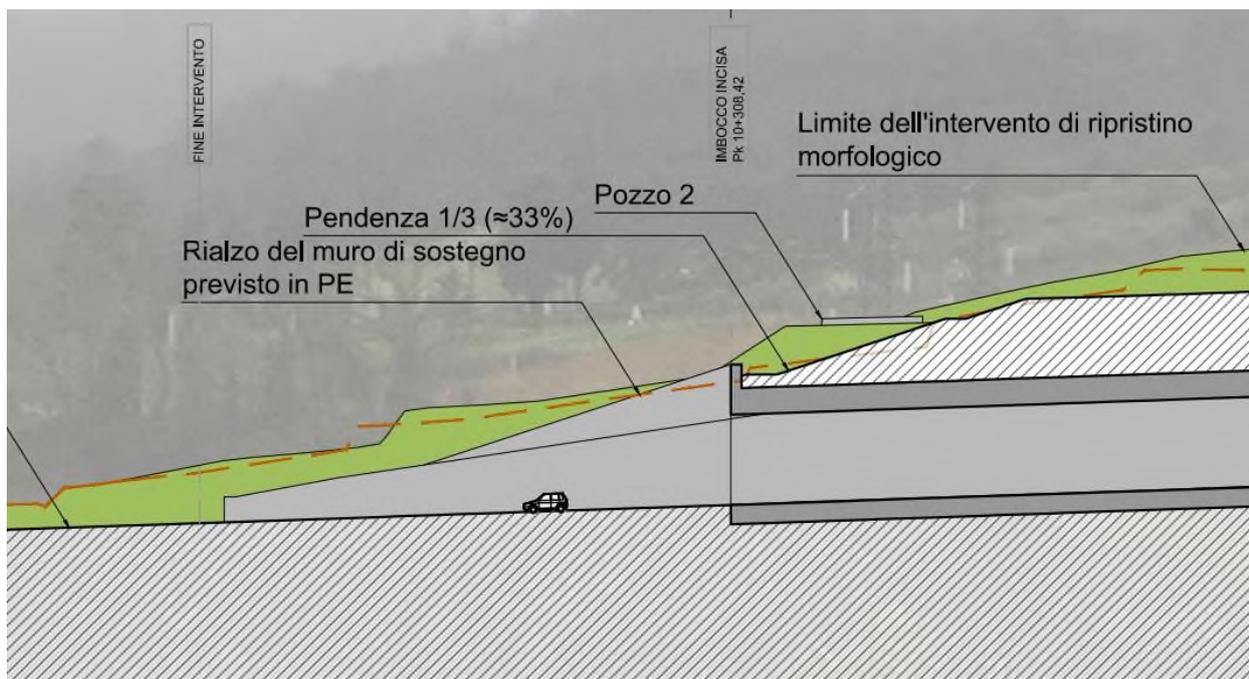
Profilo in asse galleria all'imbocco sud
